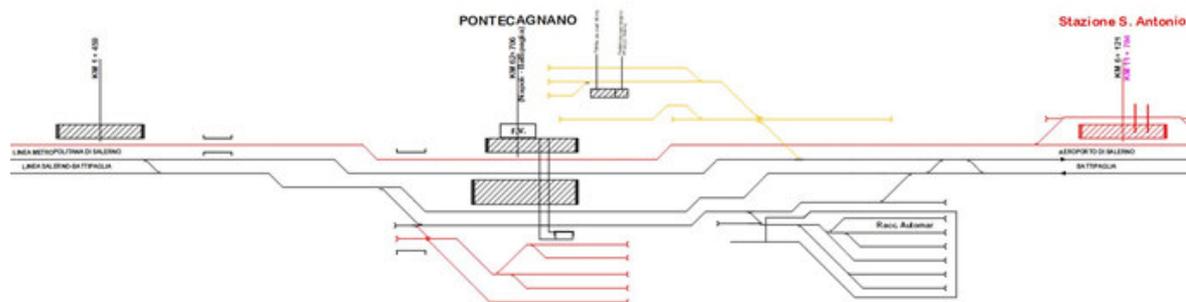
Modifiche PRG di Pontecagnano (assetto del PMZ : giallo attuale – rosso futuro lotto 0.0)
